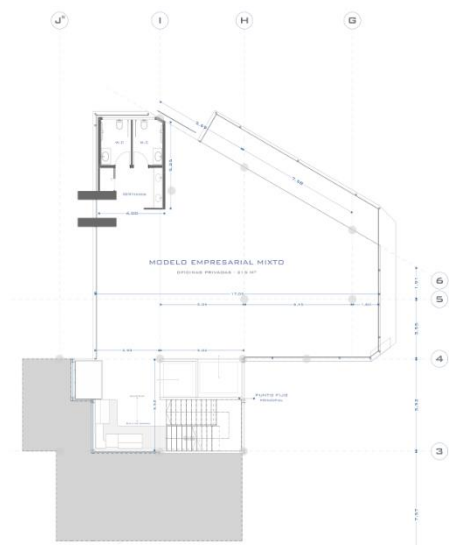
Plantas tipo - modelo empresarial mixto – Autoría propia.
